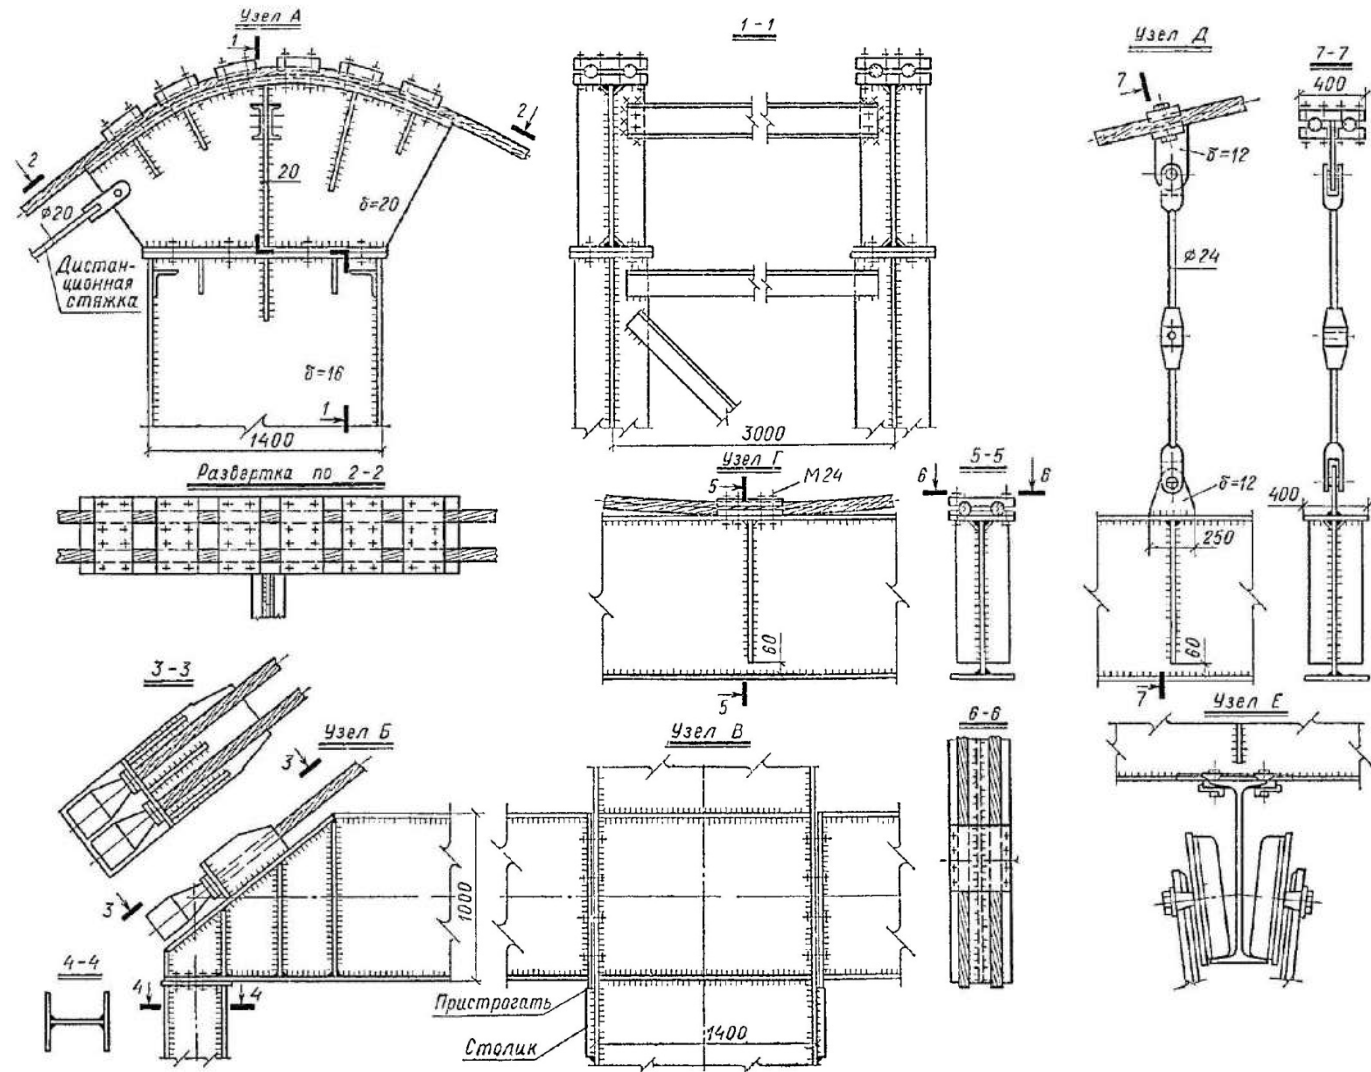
, б. Промышленное здание с висячим покрытием. Узлы
